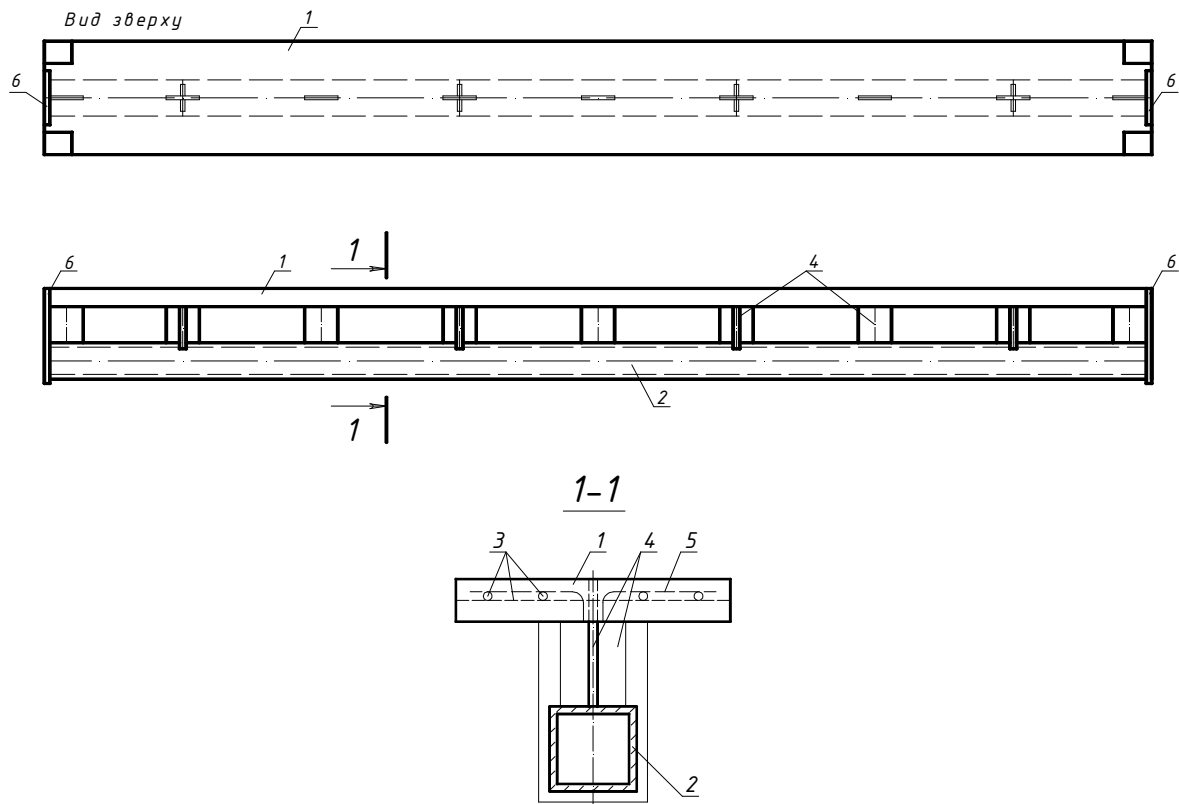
Сталезалізобетонна балка з винесеним армуванням квадратною трубою:
